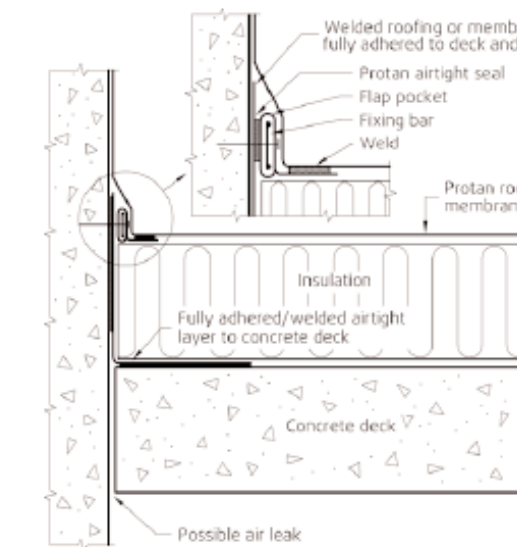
Принцип герметизации примыканий кровли на бетонном основании (Новое строительство и реконструкция)
